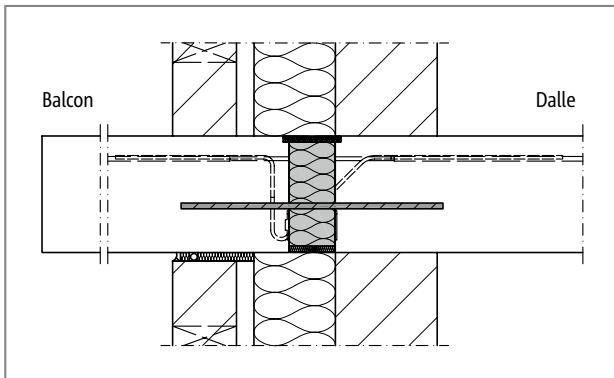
Schöck Isokorb® T Type H-NN : Avec T type K-E, K-T ; raccordement avec isolation du noyau
